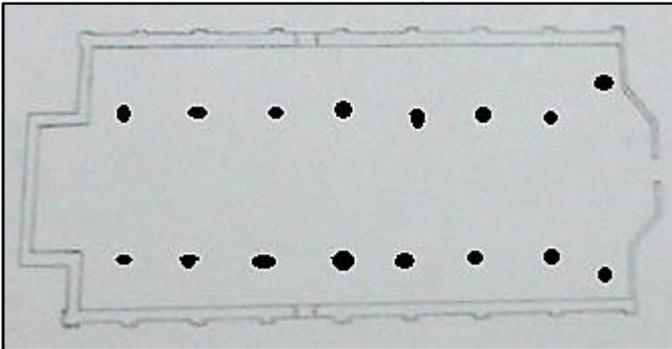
Planta baixa da Igreja, com a disposição das oito colunas internas, que formam a cruz latina.
